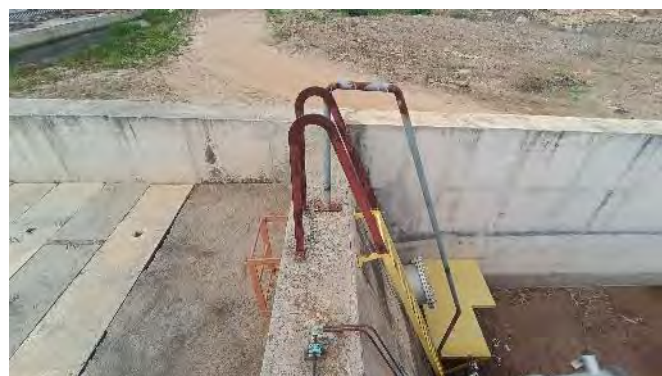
Barragem Barreiro – Escada da Válvula Dispersora
